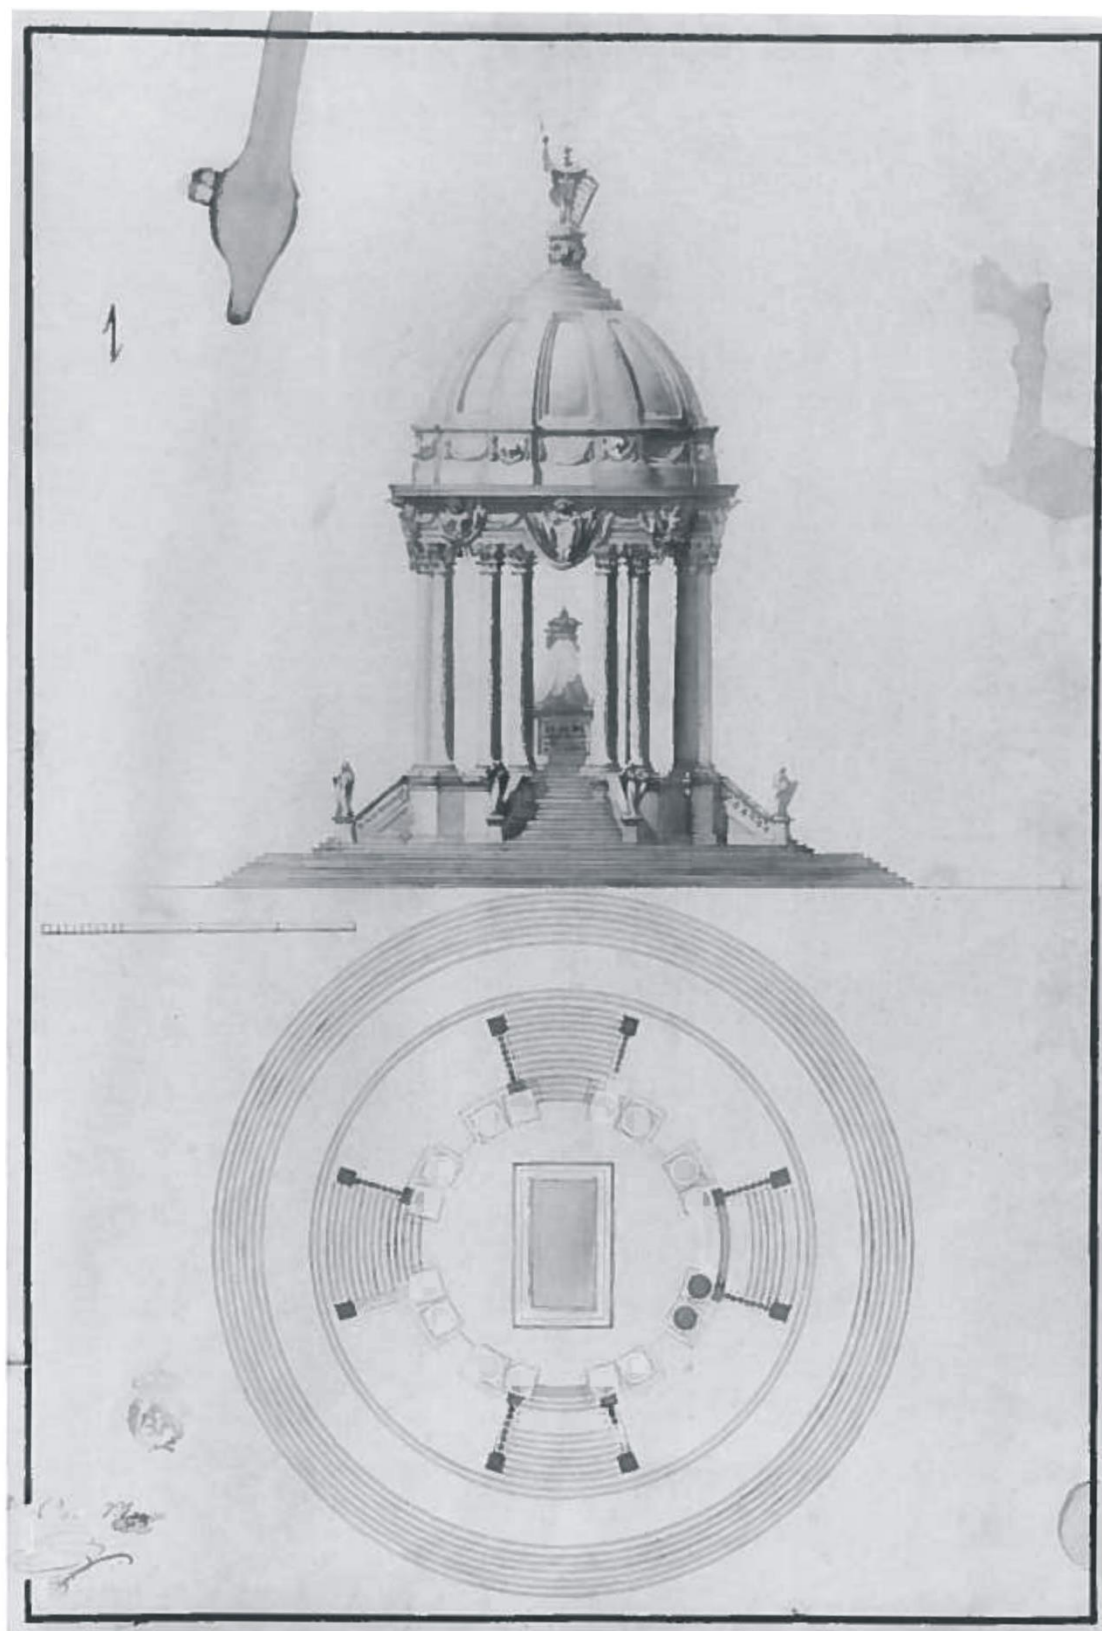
Dibujo A-3563: Planta y alzado, Archivo R.A.B.A.S.F.
